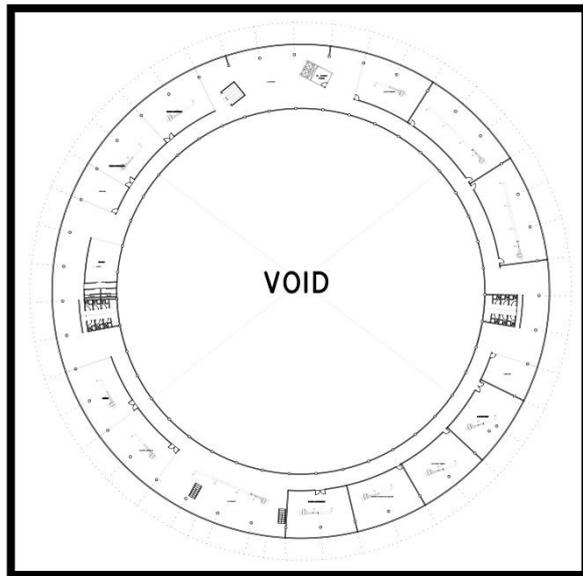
Rencana air kotor bangunan paddock dan tribun
